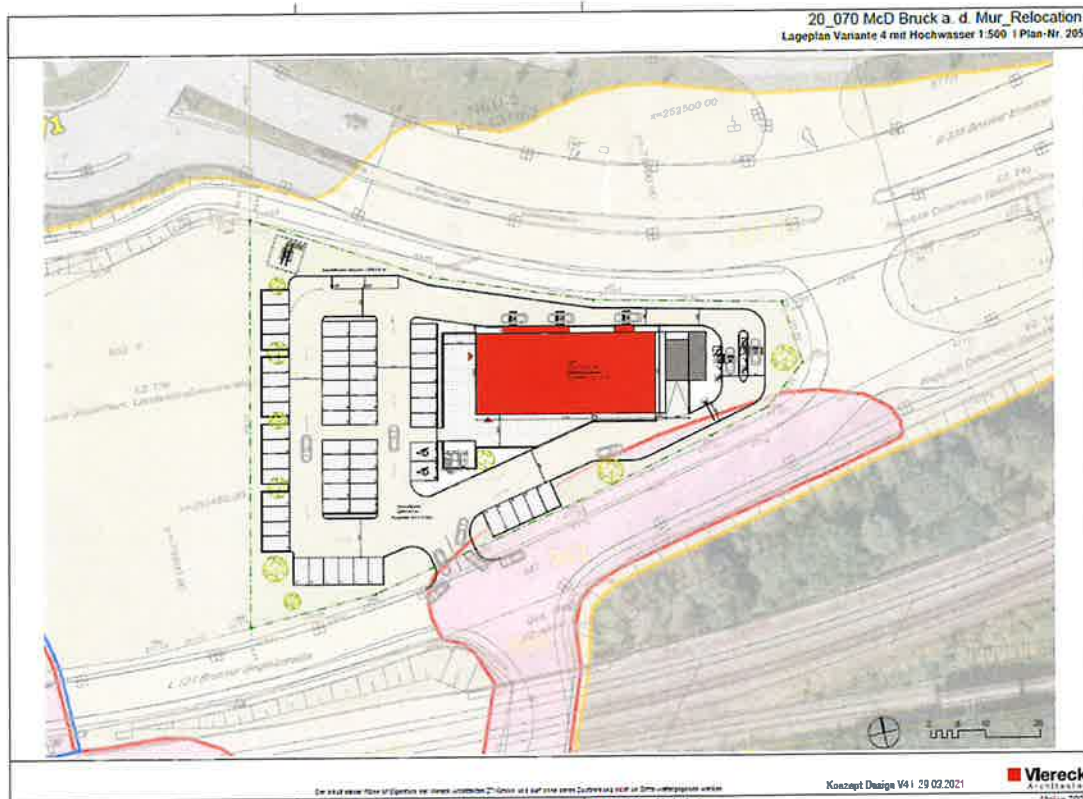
Lageplan Projekt (Quelle: Vierkant Architekten, 29.03.2021)
